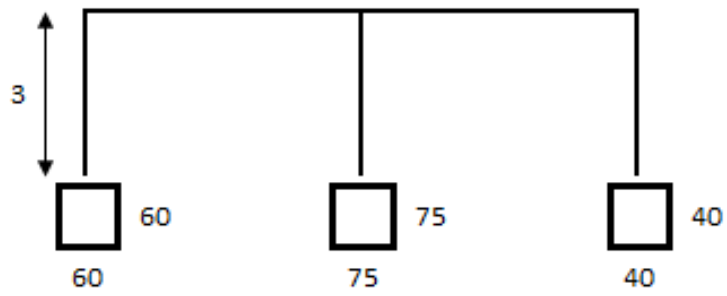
Configuración en planta del modelo de la Torre Picacho
